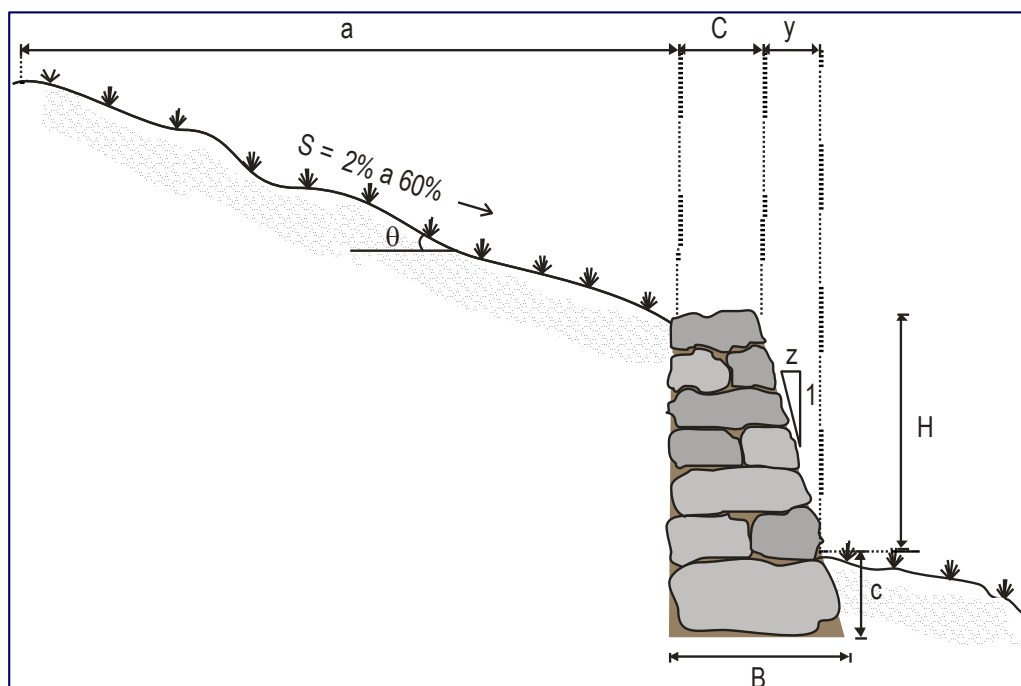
Forma de construcción de un muro de contención tipo pirca
